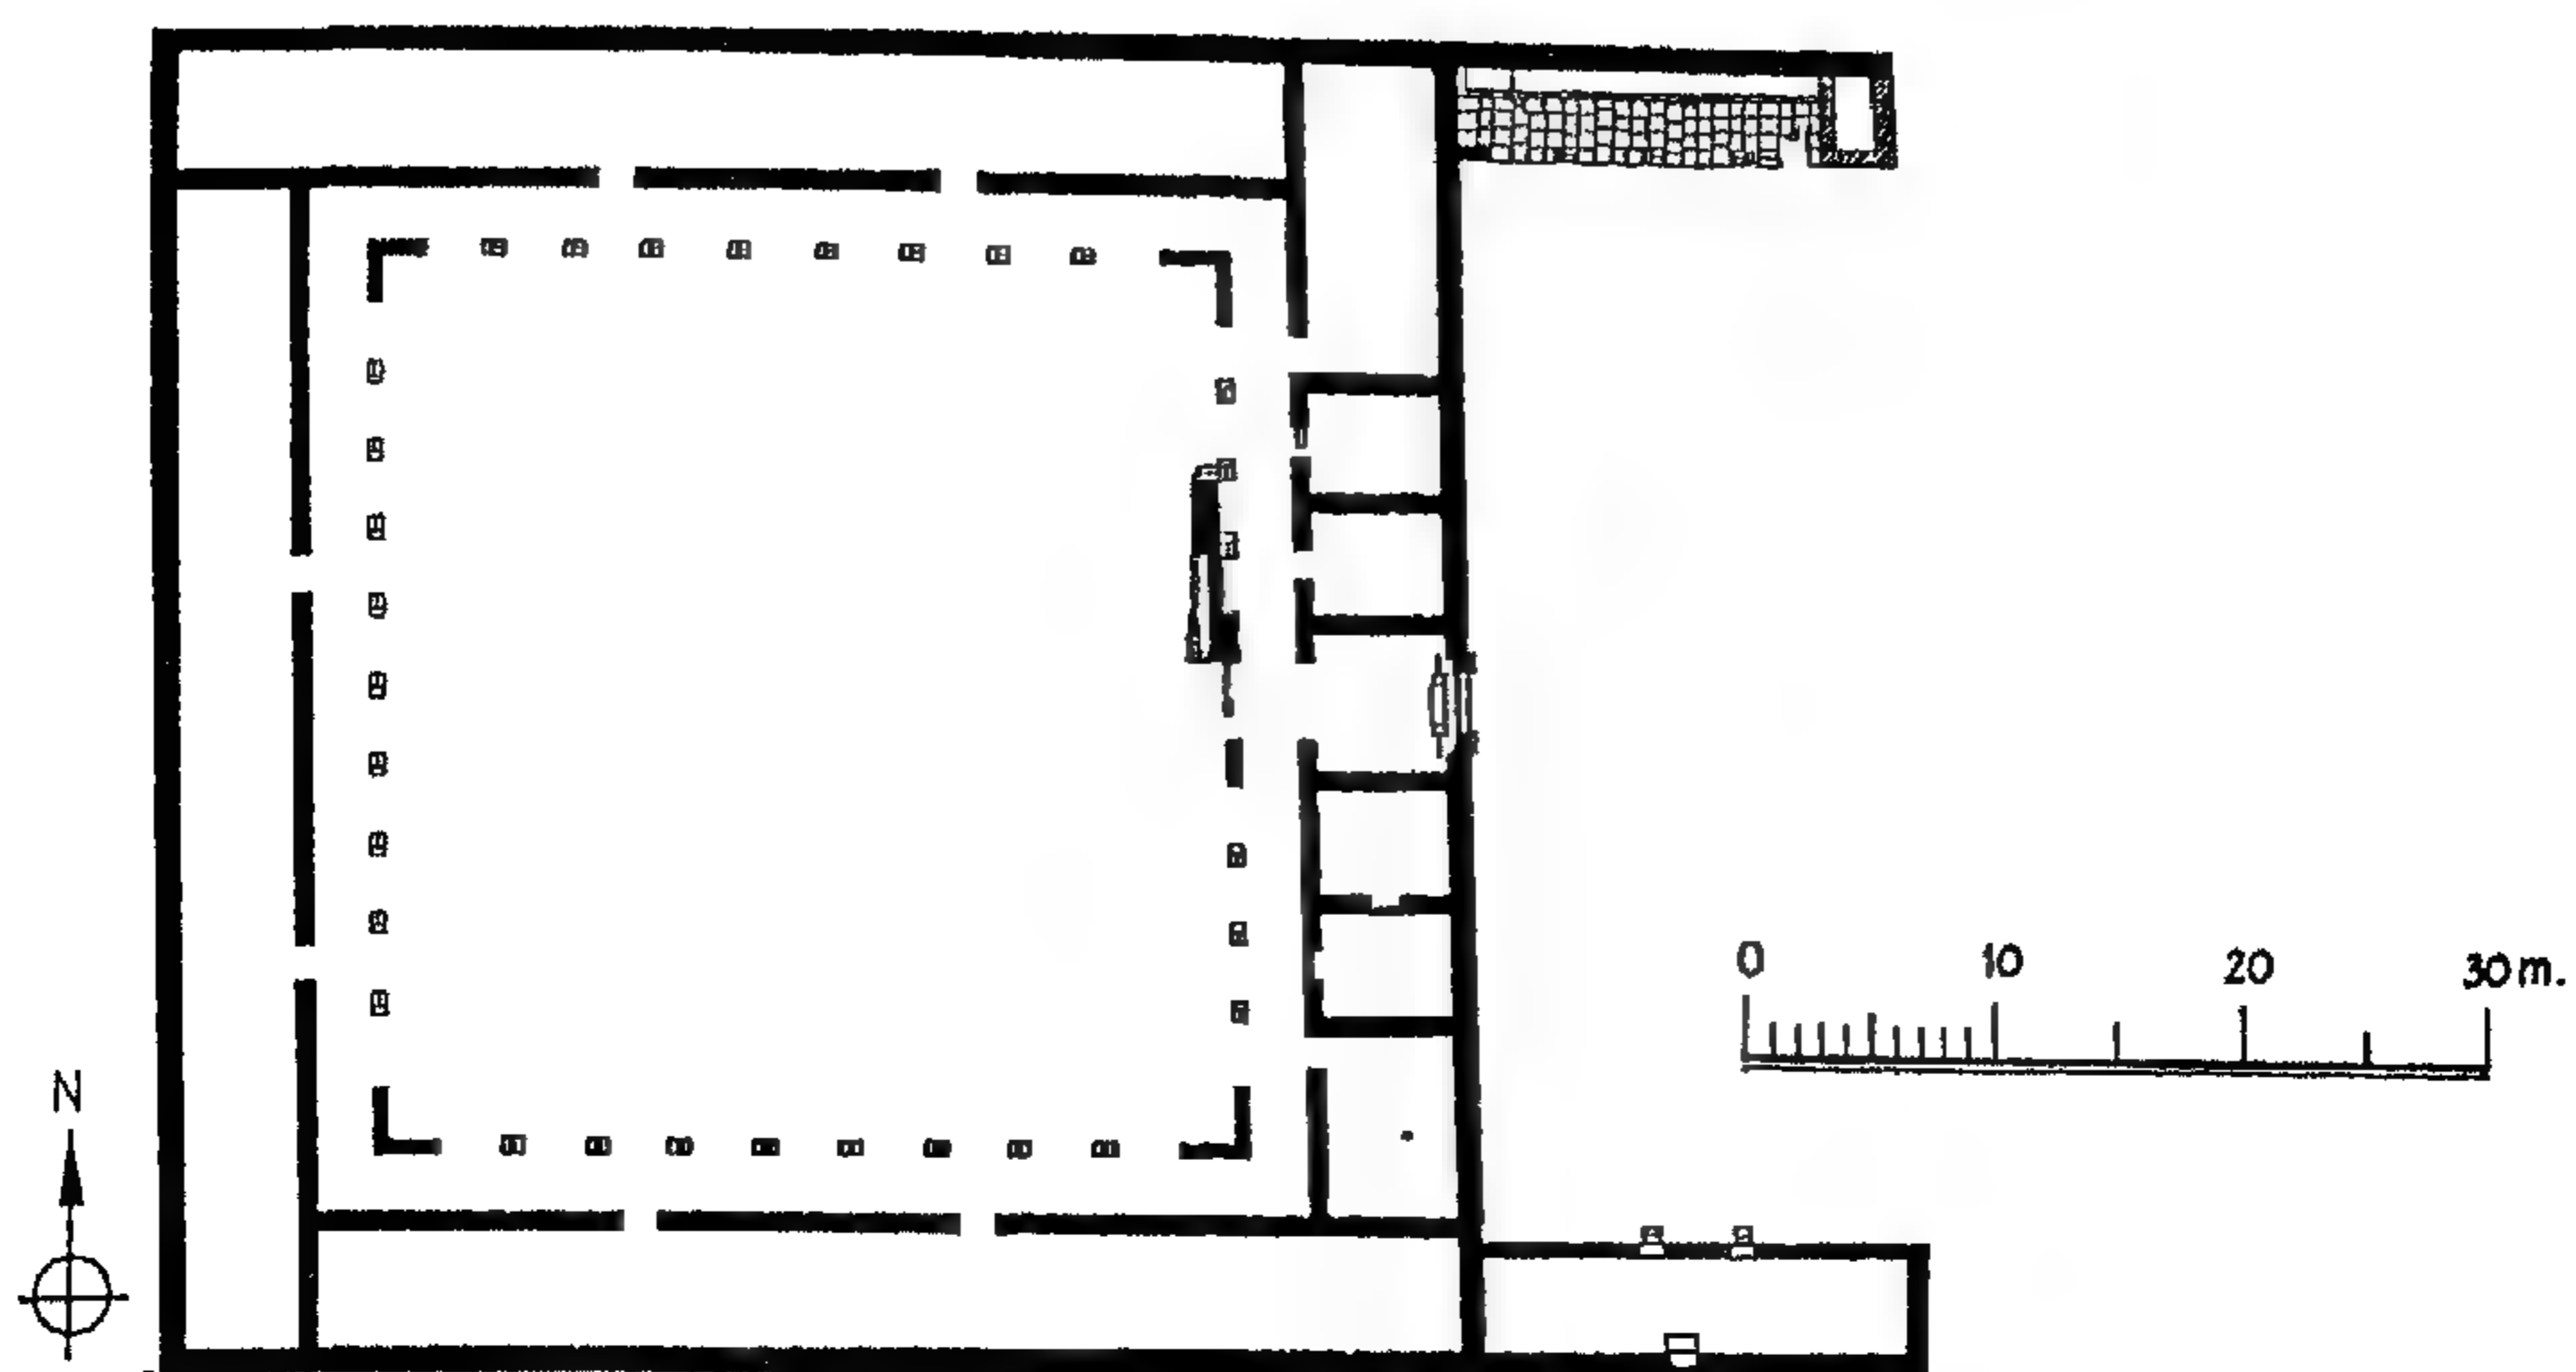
مسقط أفقي لحمام قصير عمره . (عن : كريزول) .
